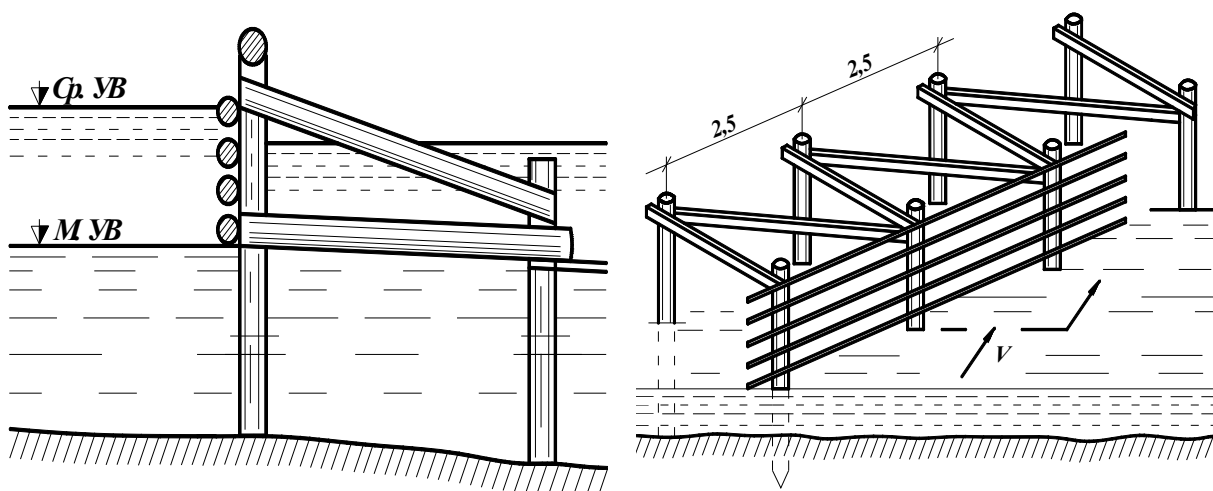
Продольная сквозная берегозащитная конструкция из дерева
